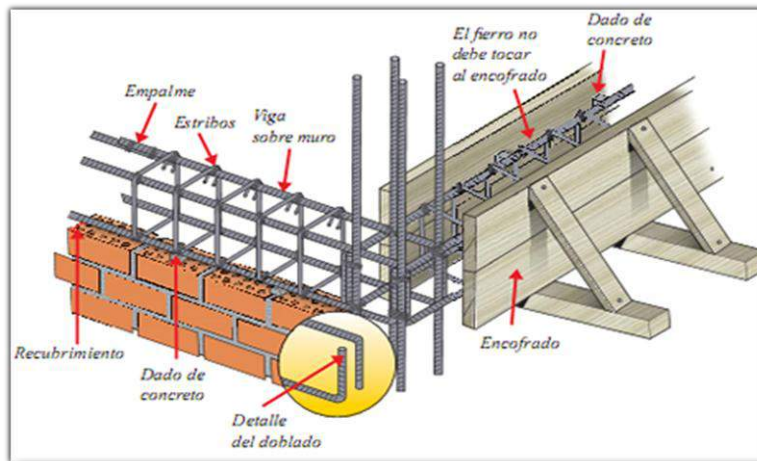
Trabajos previos para elaboración de vigas de concreto armado
